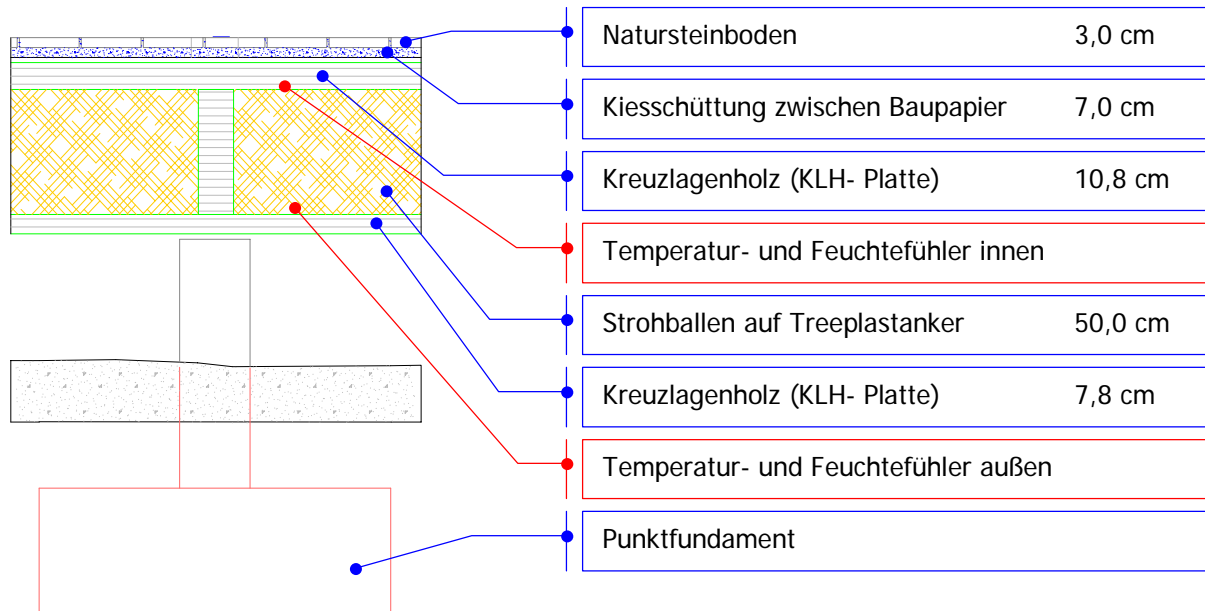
Bodenaufbau mit Einbaulage der Sensoren
